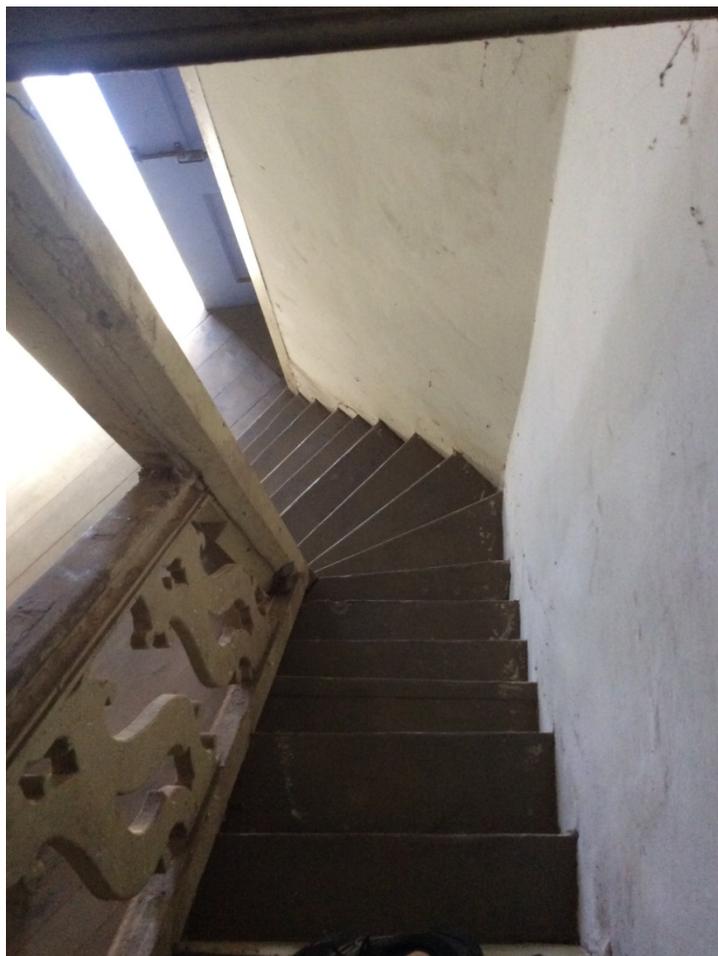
Vista K Escada junto à entrada principal acesso ao coro - Planta pavimento inferior Capela Sem escala.
